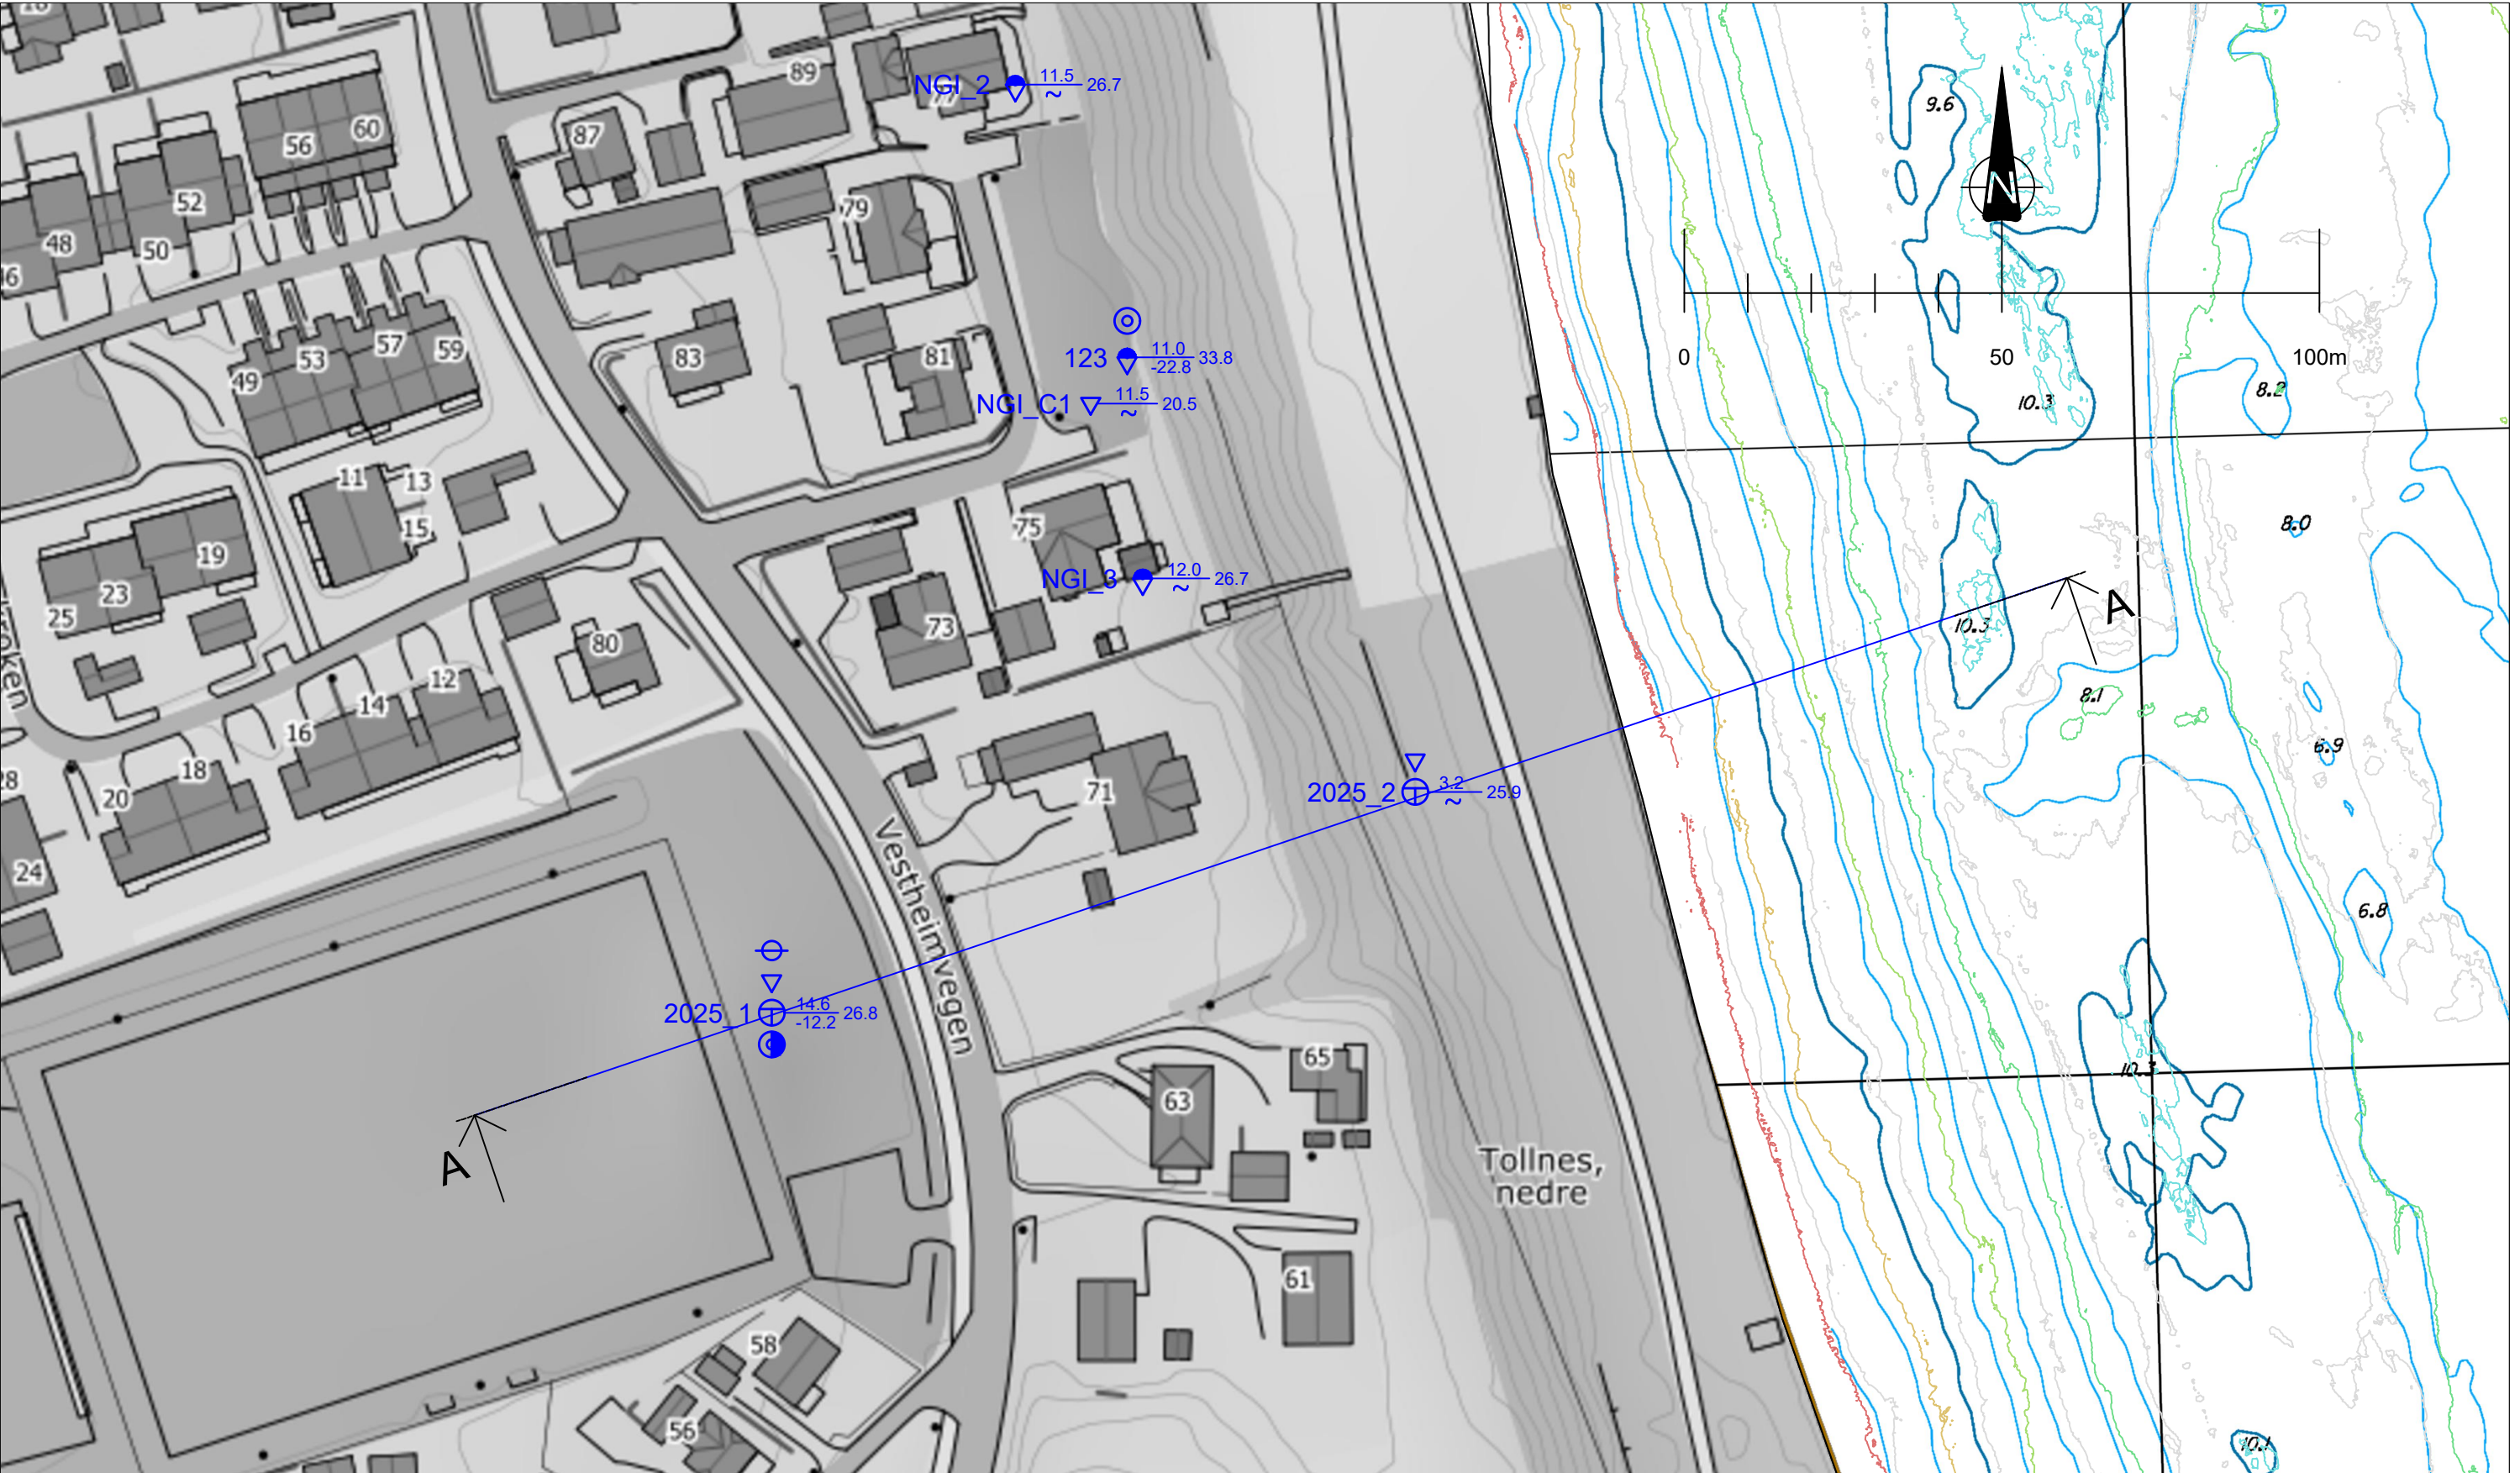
Tidligere grunnundersøkelser rundt planområdet.
